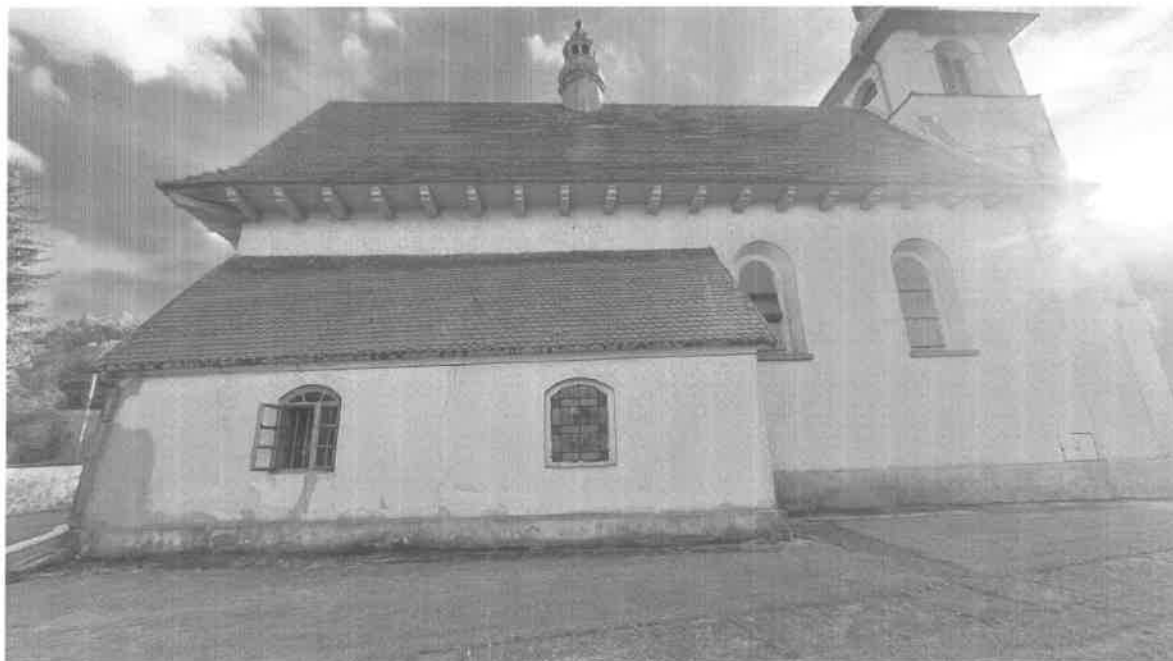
Elewacja zachodnia – frontowa. (wyk. Ł. Szatanek)
